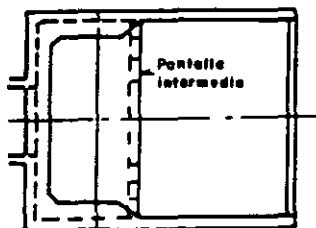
ESTRUCTURAS DE ENTRADA EN ALCANTARILLAS
